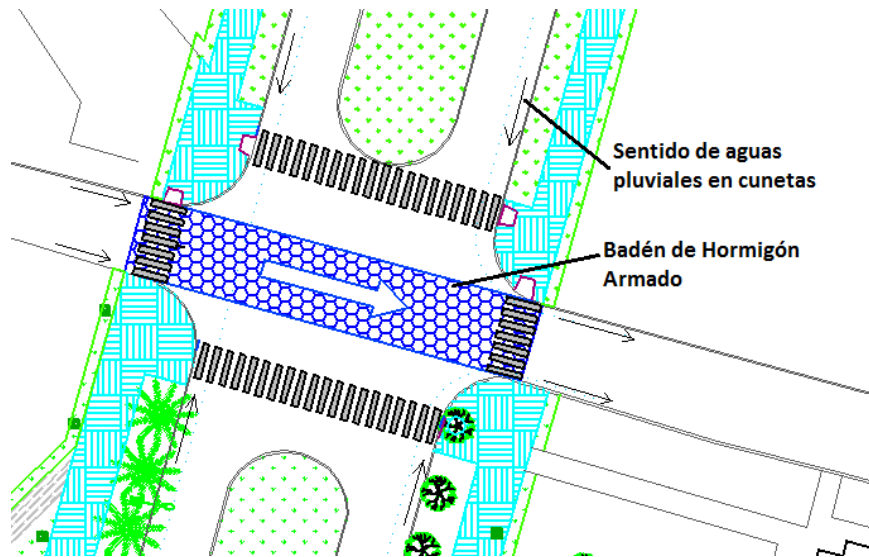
Detalles de la cuarta bocacalle propuesta
